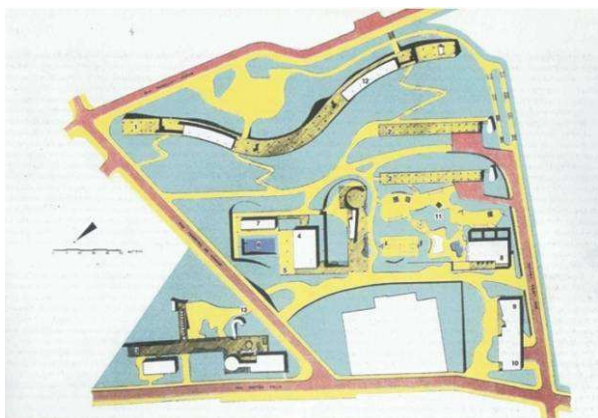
Plano geral da proposta. Fonte: Bonduki, 2000.
